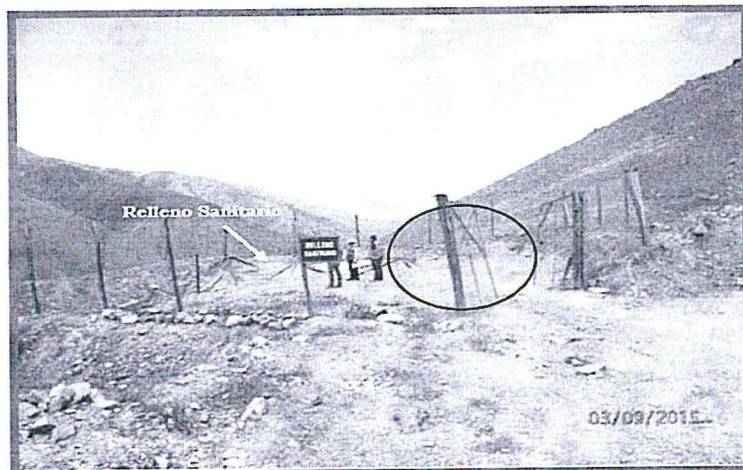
Hallazgo N°6, Vista del relleno sanitario. Coordenadas (Datum GWS84) N8251083, E661053.
